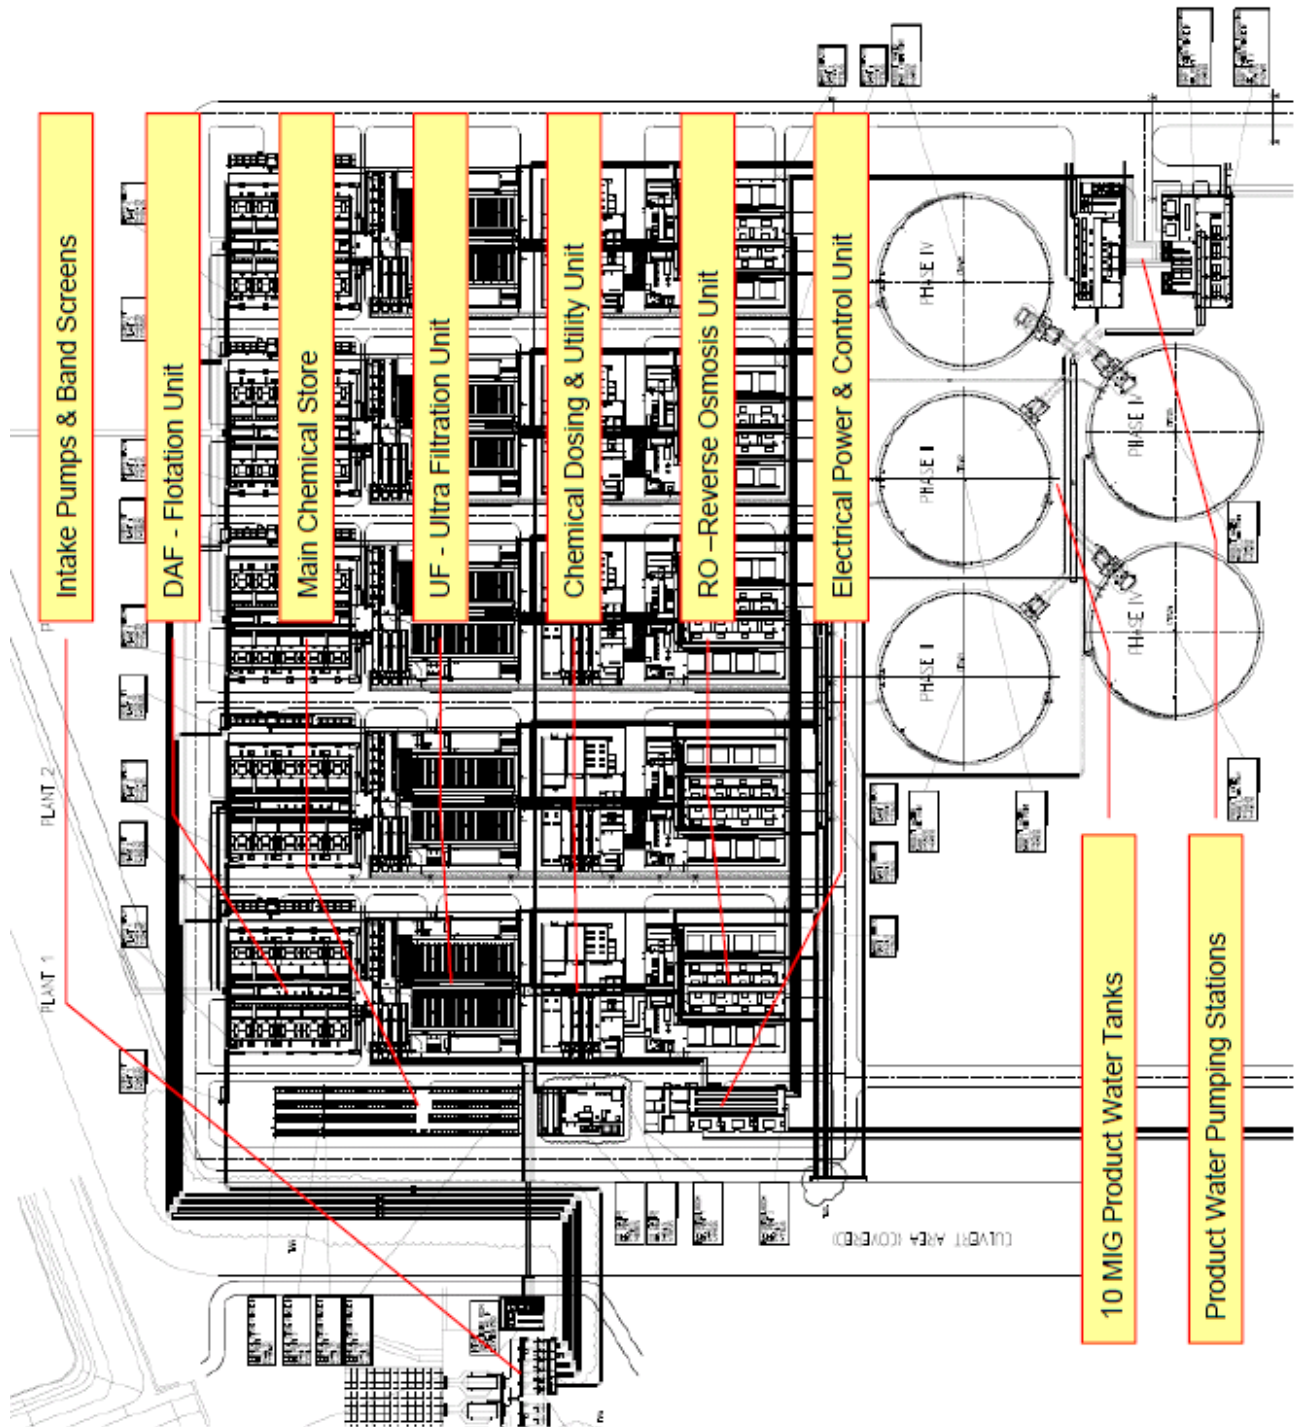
Planimetria dell'impianto di Hamriyah. (Codemo et al., 2009). In analogia con l'impianto dimensionato nel presente lavoro i pre-trattamenti sono costituiti dalle unità di flottazione ad aria disciolta e di Ultrafiltrazione. Tuttavia nell'impianto di Hamriyah la sezione di osmosi inversa opera con un singolo passo, mentre nell'impianto dimensionato nel presente lavoro si effettua un doppio passo. Si osservi che così come dimensionato l'impianto la sezione dei pre-trattamenti occupa un'area dello stesso ordine di grandezza della sezione di osmosi inversa.
